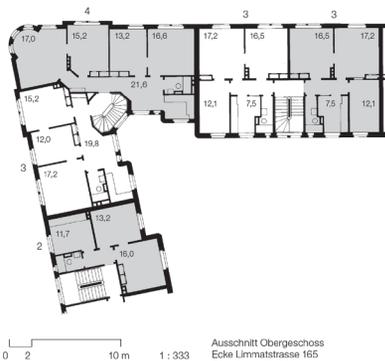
Limmat I, Ausschnitt Grundriss OG
